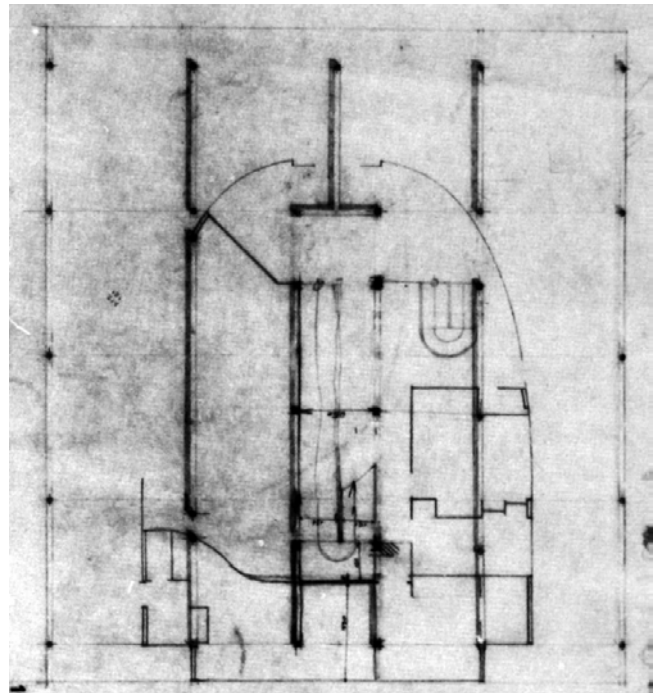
Croquis de las vigas de canto del techo de la planta baja de la *Villa Savoye* (FLC-19556). Fuente: Fondation Le Corbusier.
